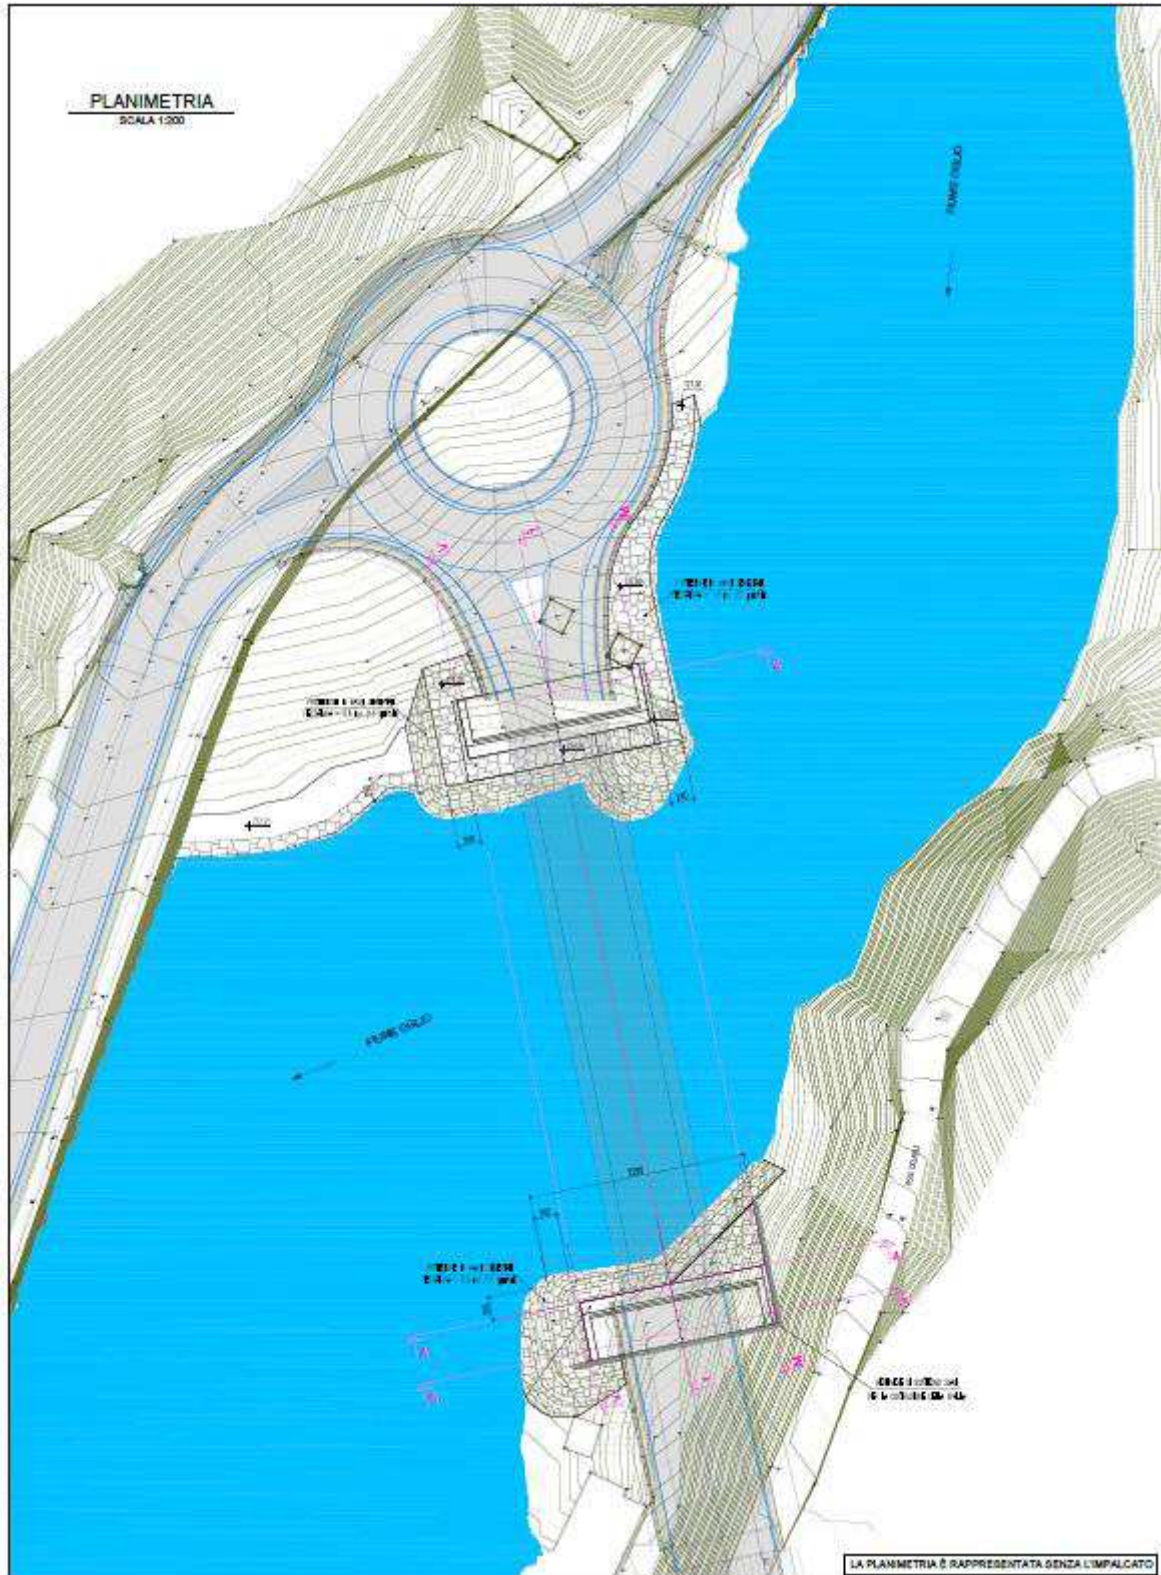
Planimetria dell'intervento con indicazione delle aree di esondazione per la piena di progetto.
